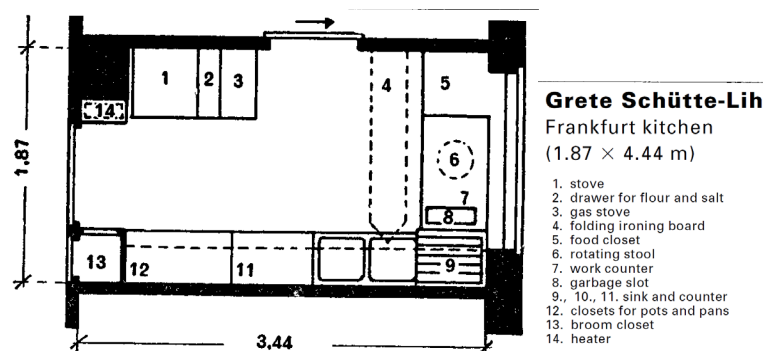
Planta e respetiva legenda da Cozinha de Frankfurt
